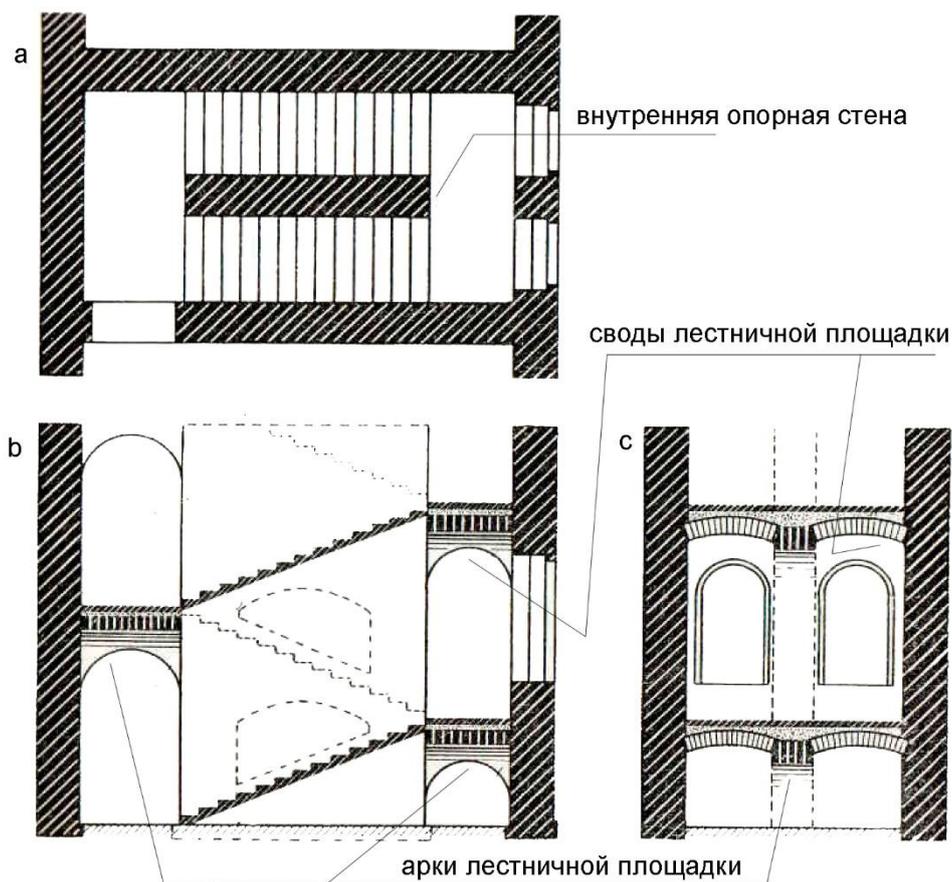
Лестница на стенах с арчно-сводчатыми конструкциями площадок: а – план; б – продольный разрез; с – поперечный разрез по междуэтажной площадке [33]
